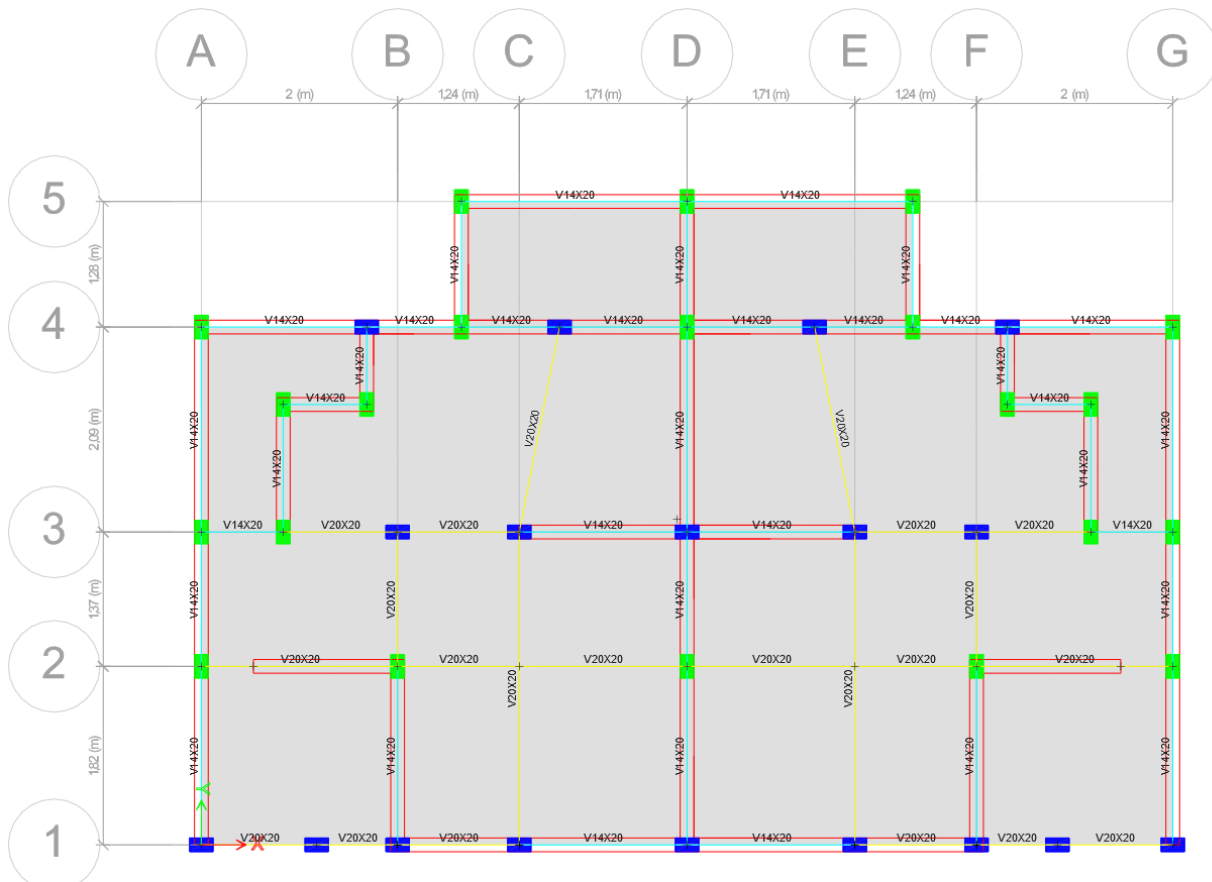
Vista en planta de la estructura de mampostería confinada. Fuente: Propia
